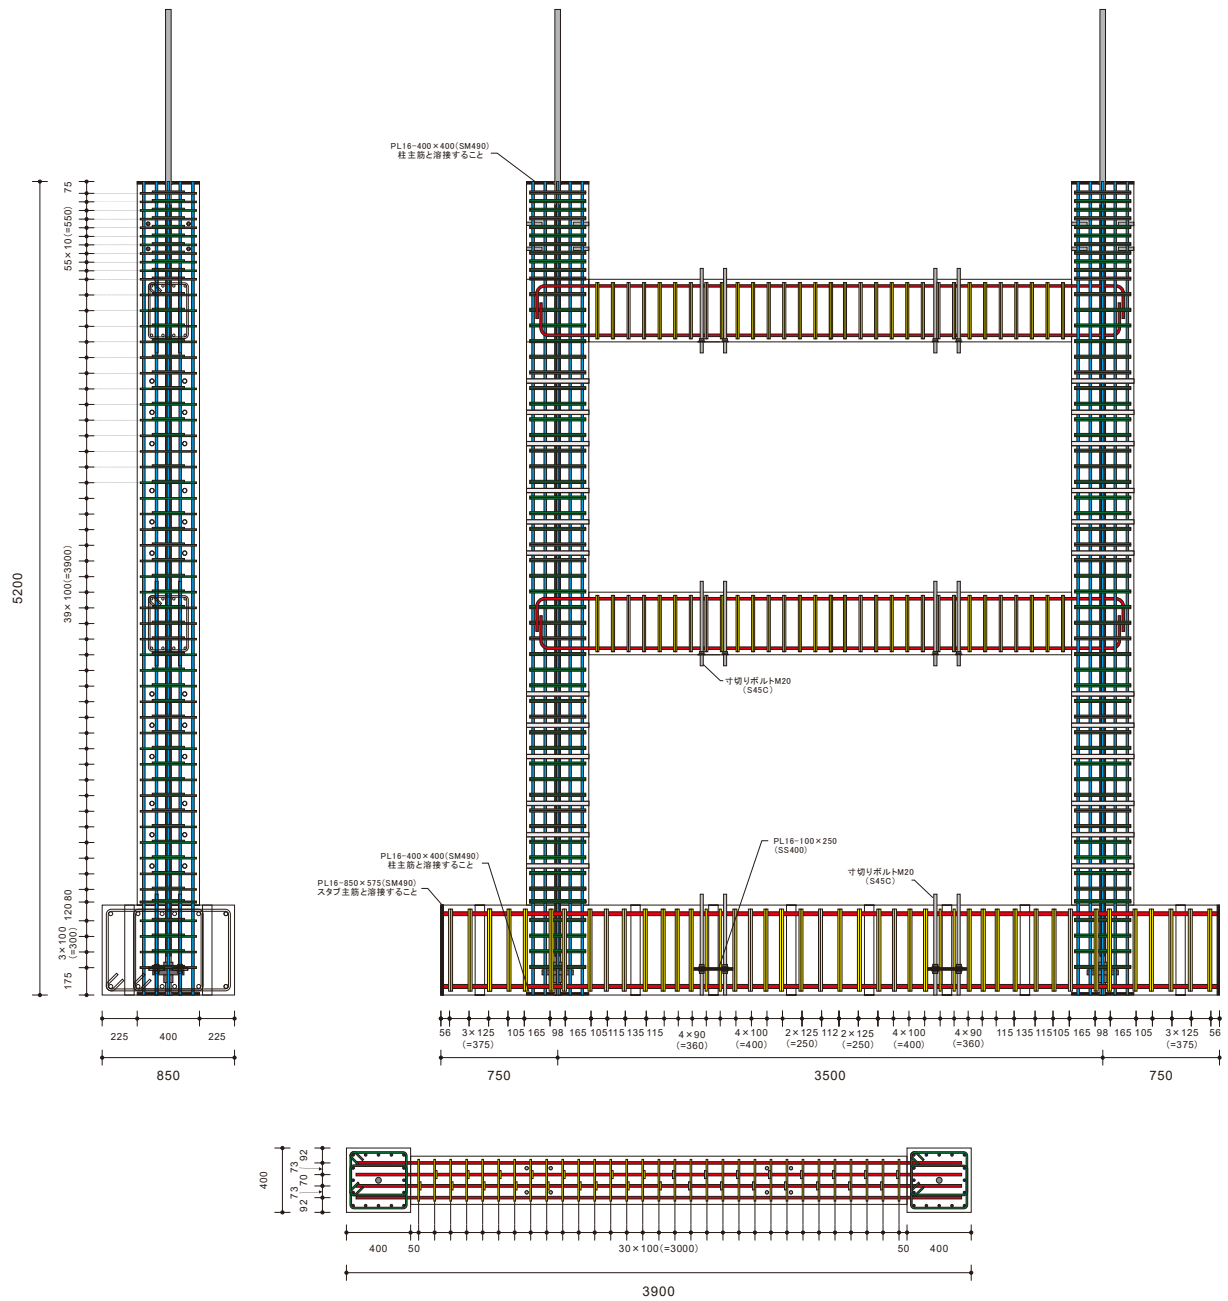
試験体 WA の RC 部分の配筋図 (単位:mm)
